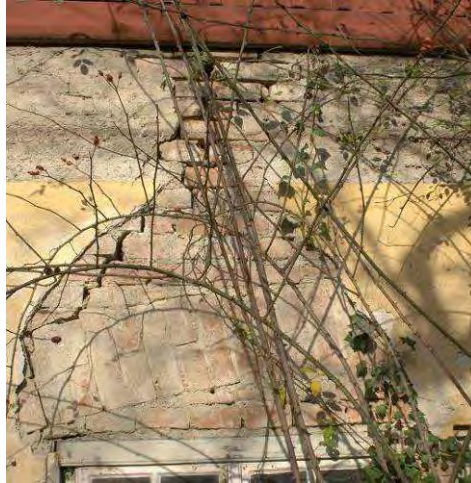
Vertikaler Riss in der südlichen Außenmauer aufgrund Seitenschubs der Dachkonstruktion
